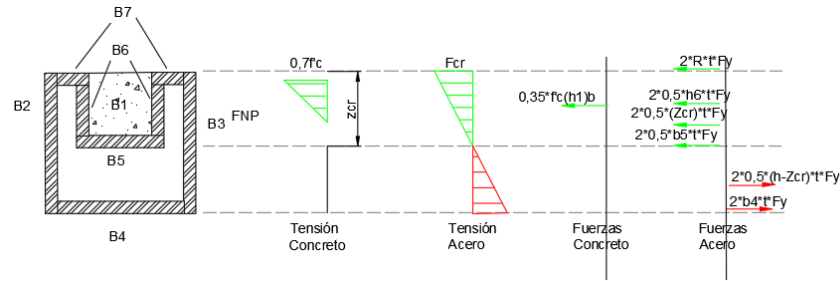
Distribución de tensiones y fuerzas en la Sección N°7 en el rango plástico.
